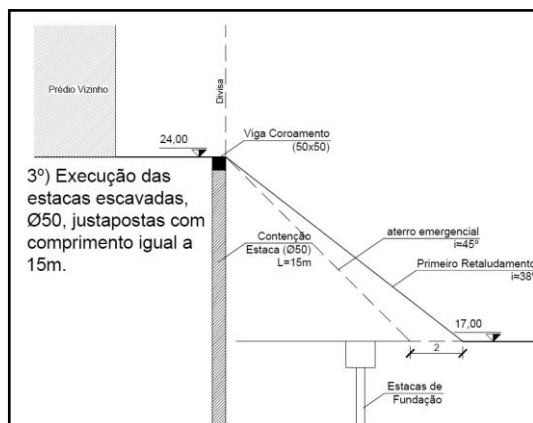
3ª Etapa: Execução das estacas escavadas e da viga de coroamento.
